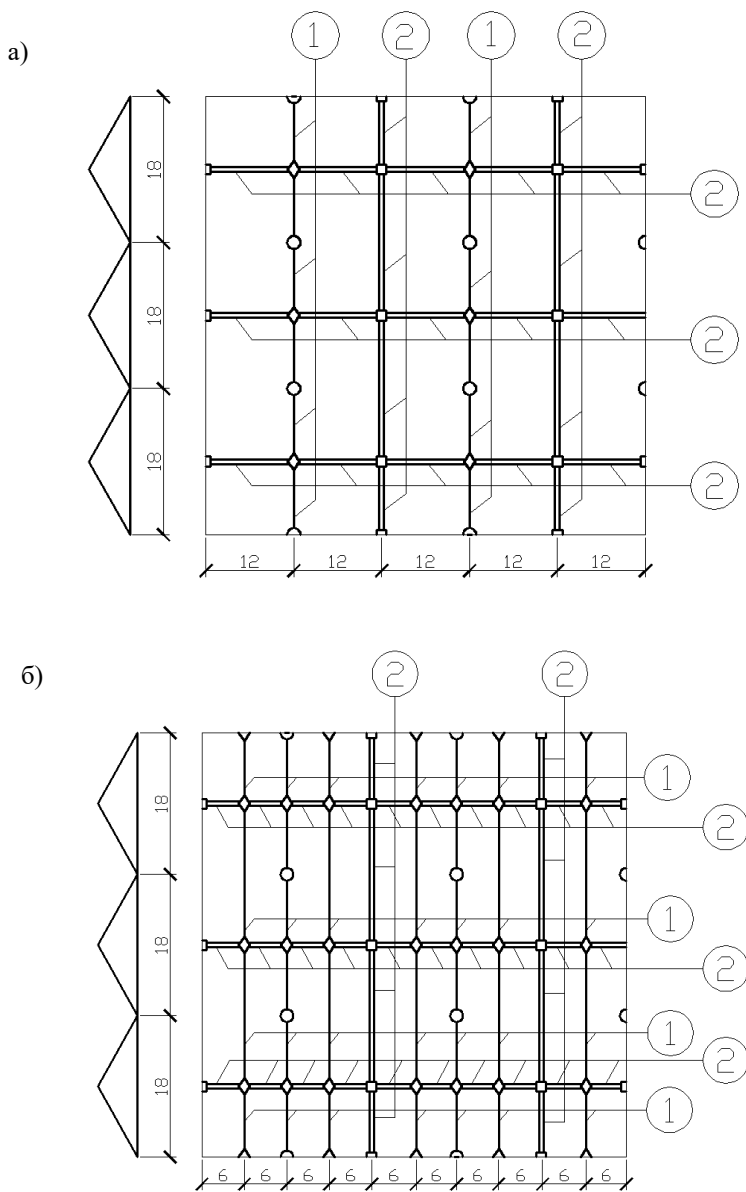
Варіанти схеми вентиляції: а) за схемою КН;
